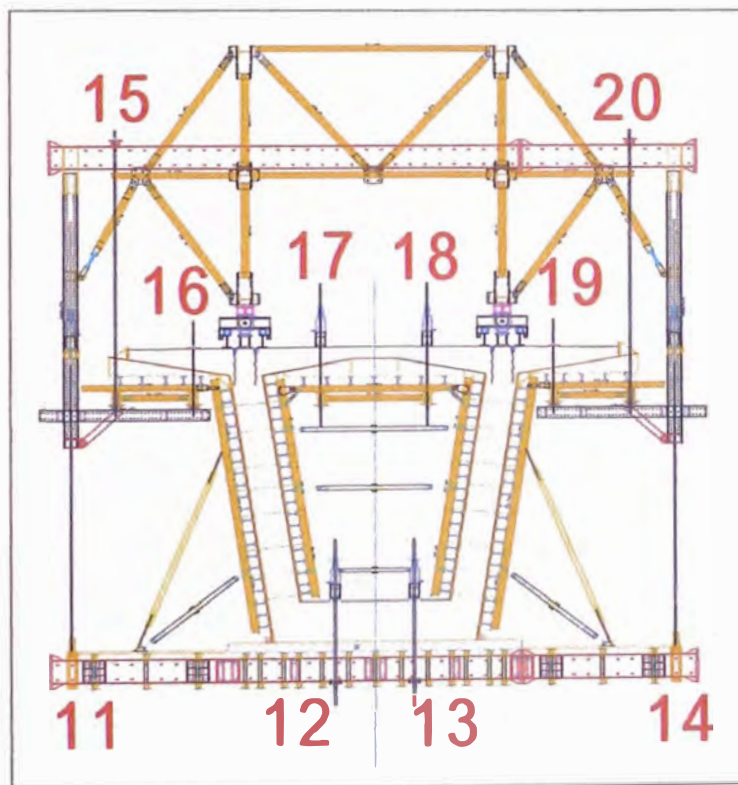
Ubicación de Cargas aplicadas a Carro y a Losa de Dovela anterior - Sección Posterior.
